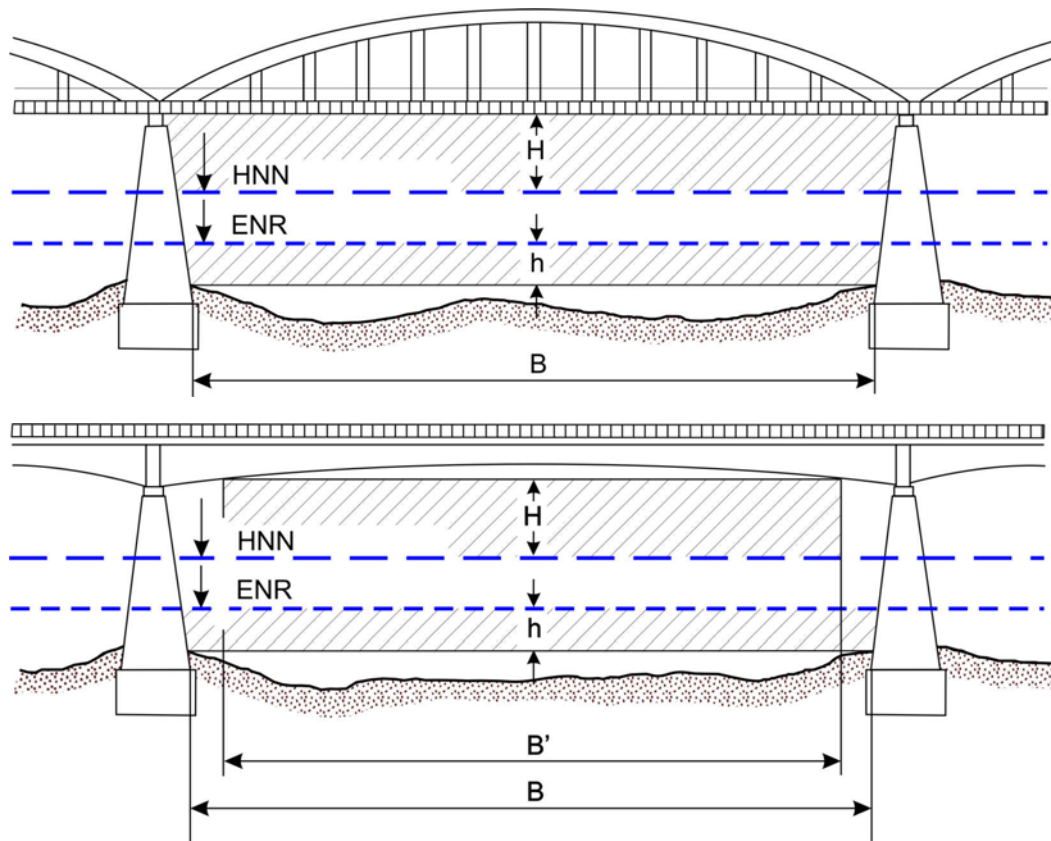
Schéma de principe d'une passe navigable d'un pont
